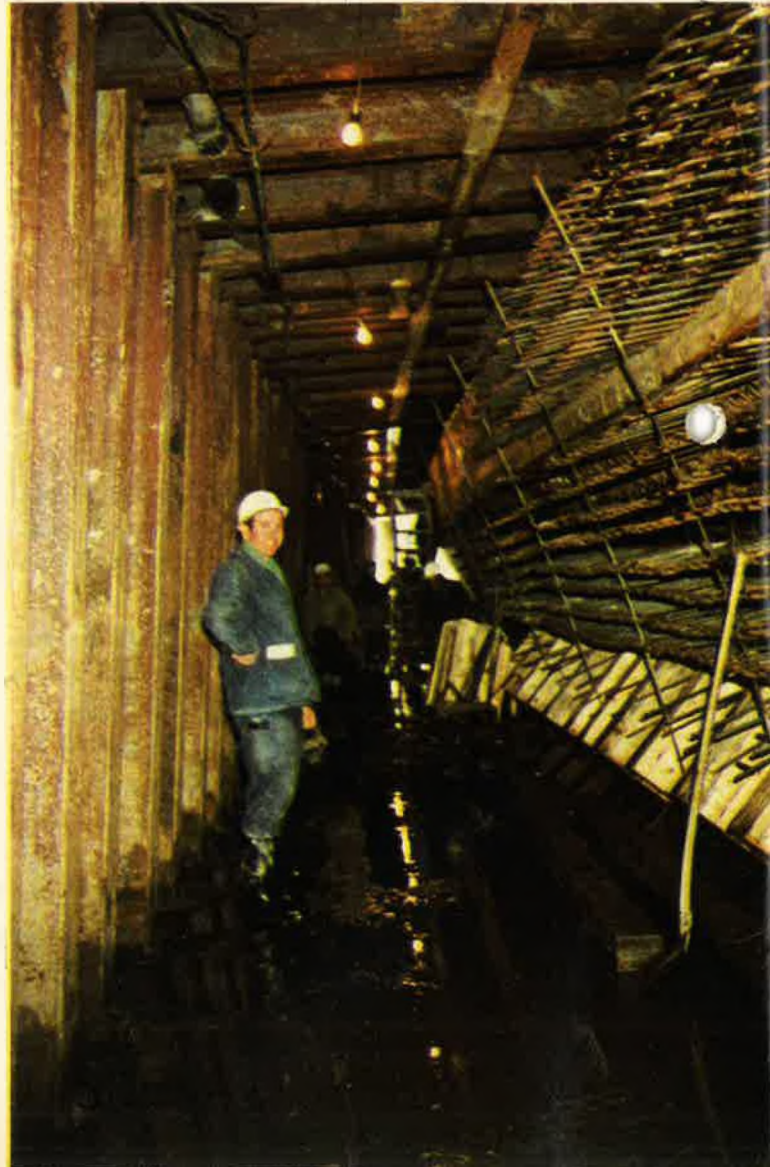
galerijen van de steunmassieven - Plaatsen van de bewa- pening.
